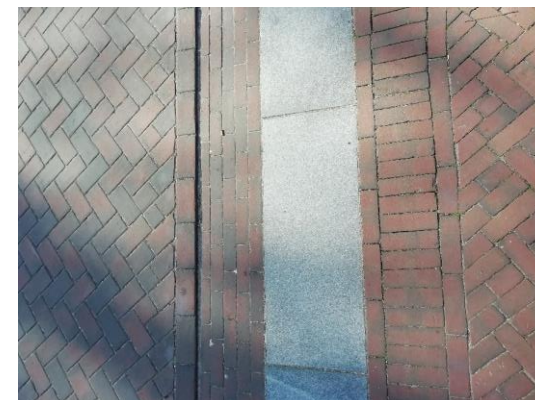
De oversteekvoorzieningen op het plein (eigen foto)
